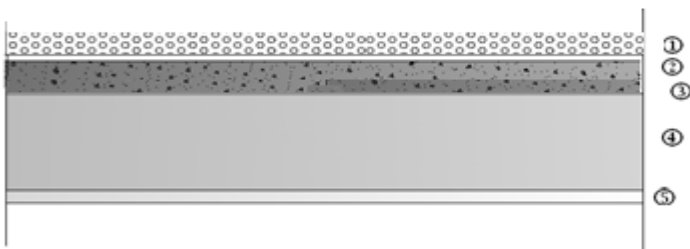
Coupe verticale de la dalle pleine du balcon.
